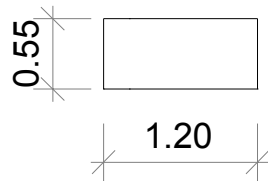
SECÇÃO DA VIGA (AUTOCAD)
